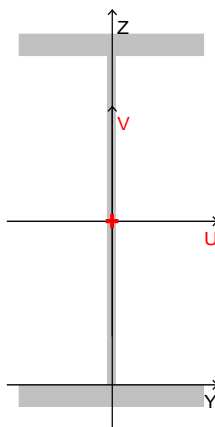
Поперечний переріз в розрізі 0-1
